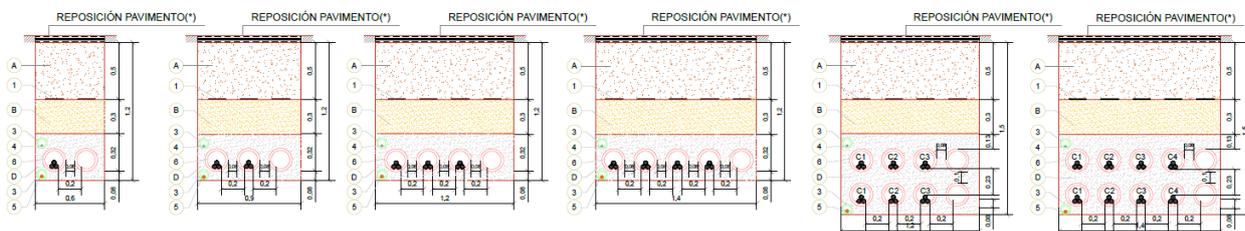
zanjas tipo conductor entubado bajo viales/caminos o drenajes.
